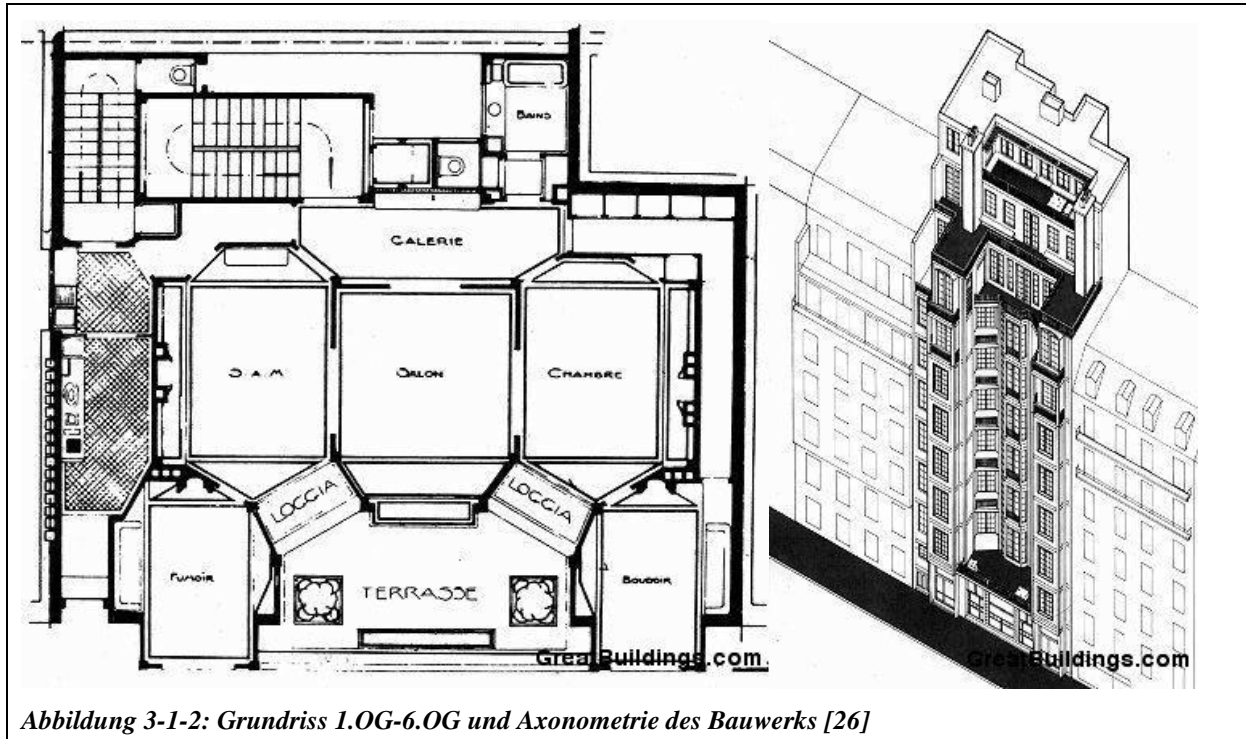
Grundriss 1.OG-6.OG und Axonometrie des Bauwerks [26]
